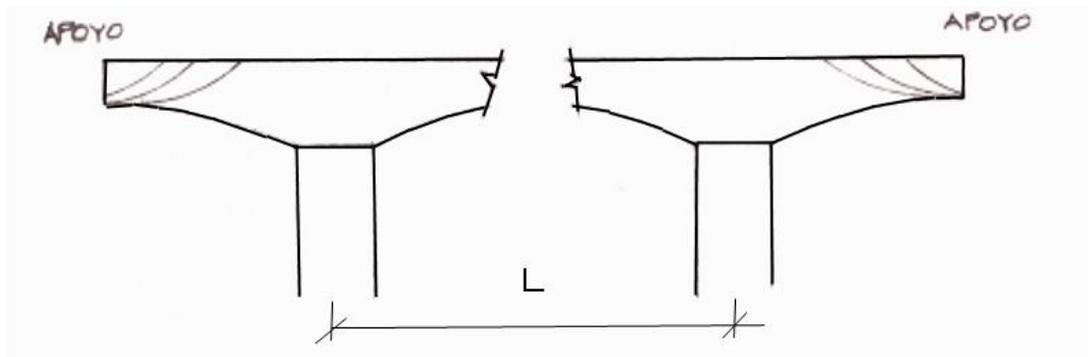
Cables tipo C, ubicados en zonas de apoyo
